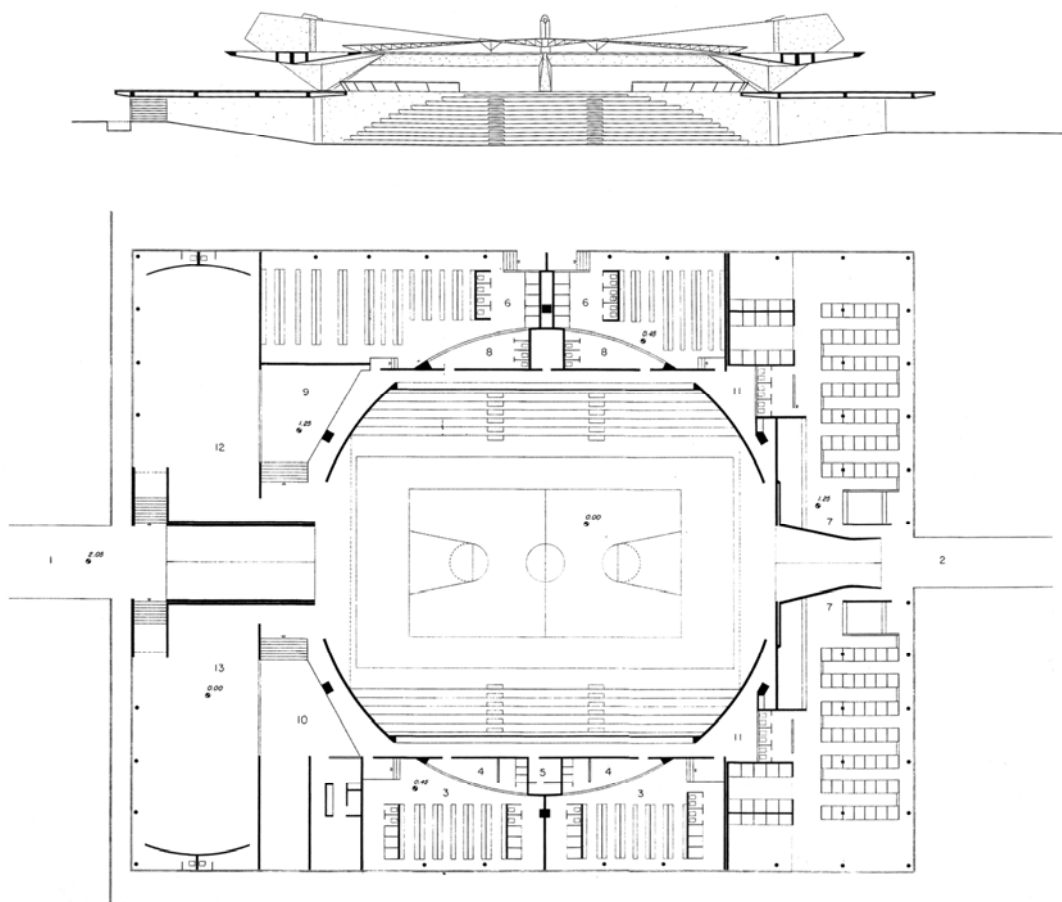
Ginásio do Paulistano. Corte longitudinal e planta do nível 0,00.
